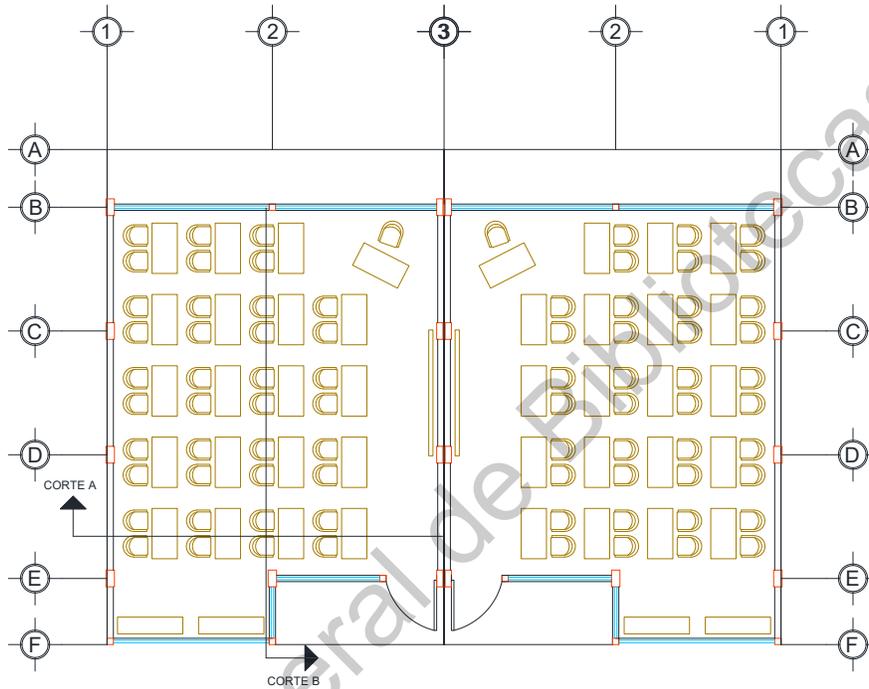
Planta Arquitectónica Zona D (Elaboración Propia)
